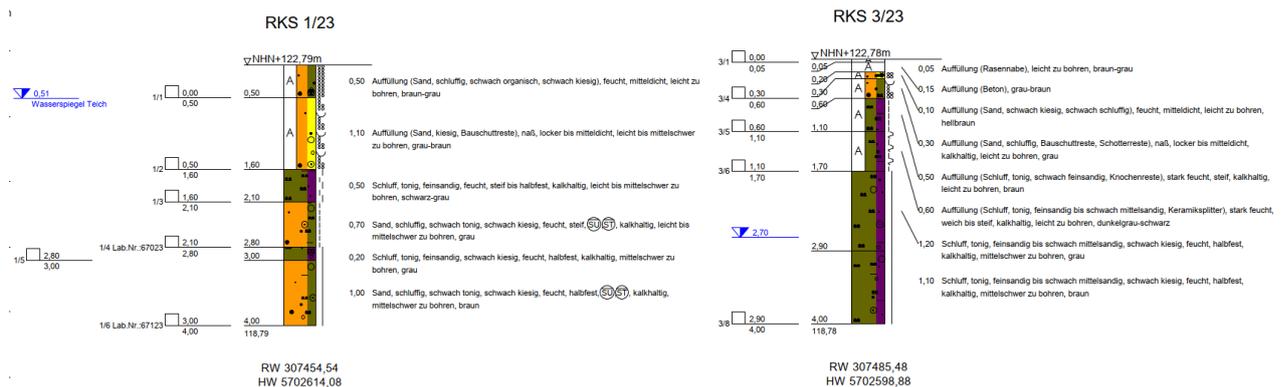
Baugrundaufschlüsse RKS 1/23 und RKS 3/23
